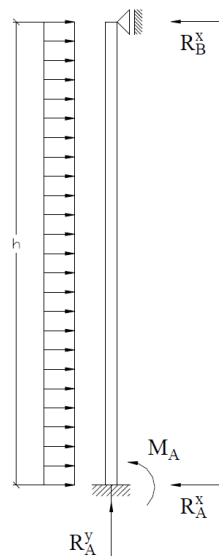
Reações no pilar da fachada de empena.(Gomes, 2019)
